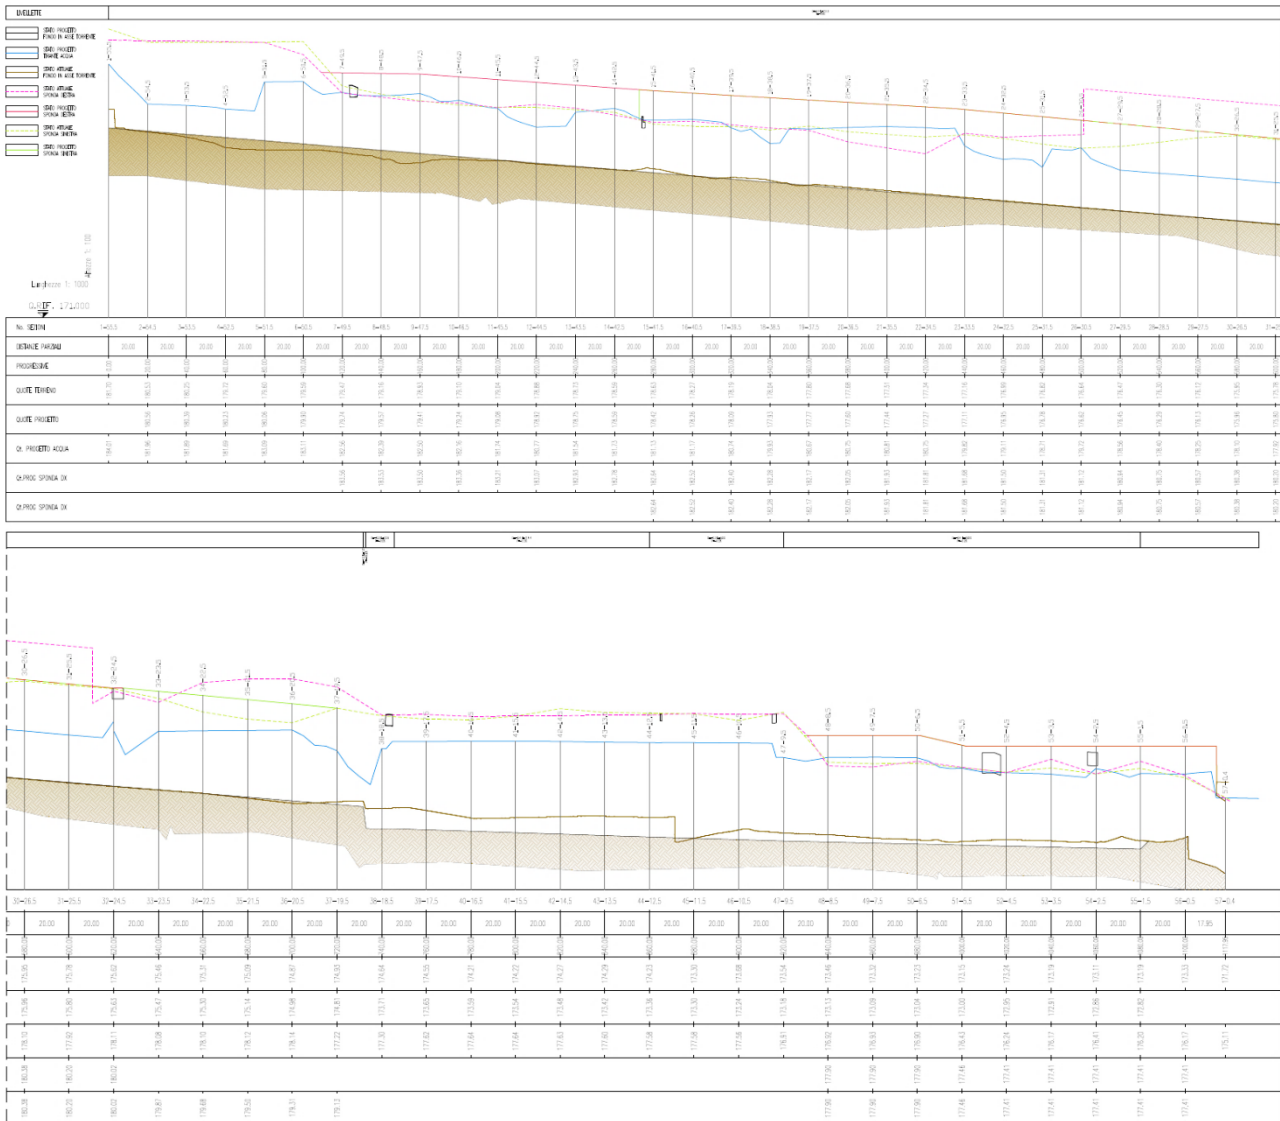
Estratto Tavola 05. Stato di progetto, profilo.
